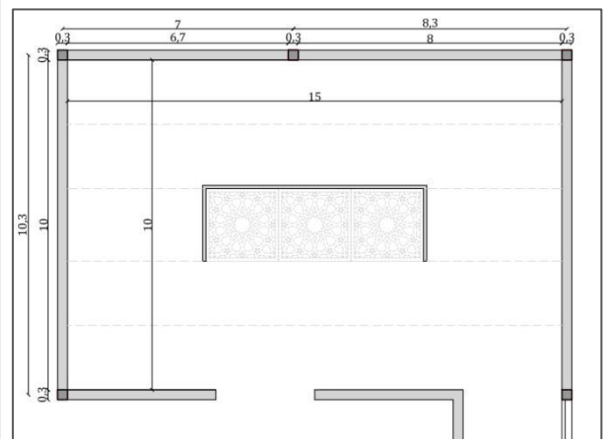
Plan de la salle d'exposition avec le mur. (Source : auteur)
